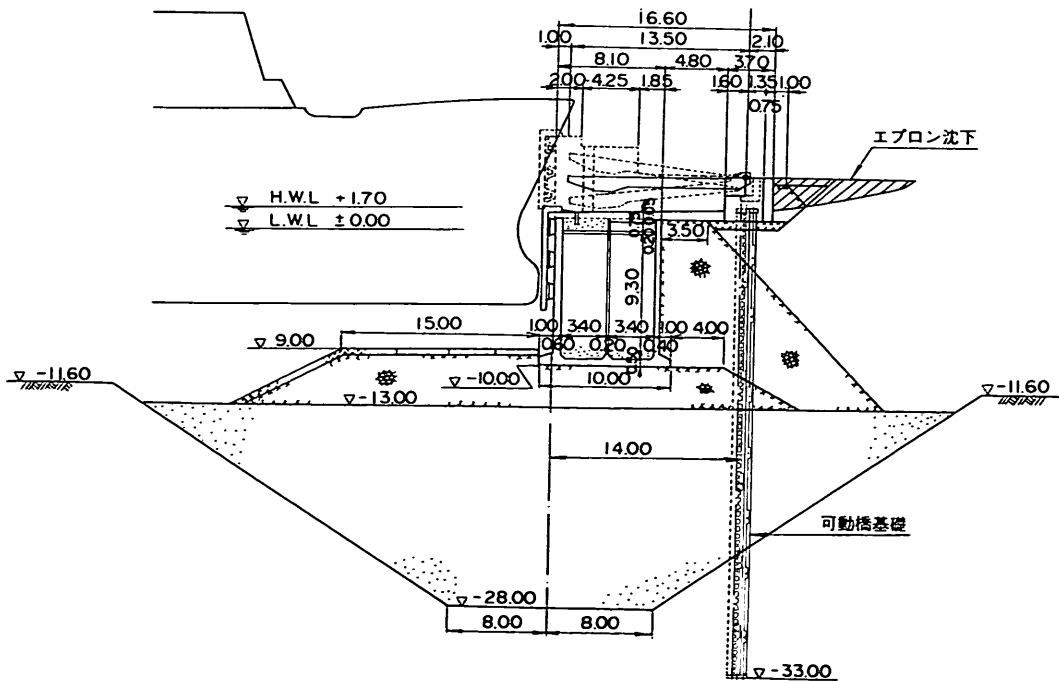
フェリー埠頭船首部断面図(六甲No.3)
